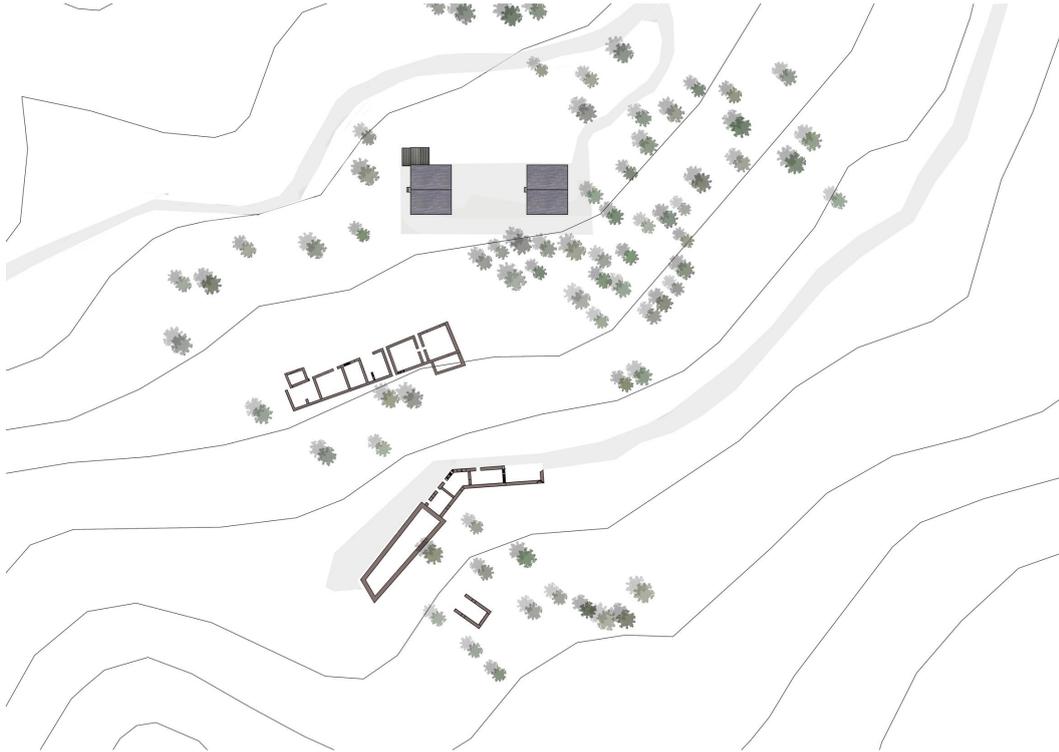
Andriani Mario.Sapatlè, Planimetria, stato di fatto
